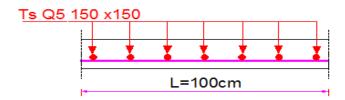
Schéma de ferraillage de la dalle de compression.
